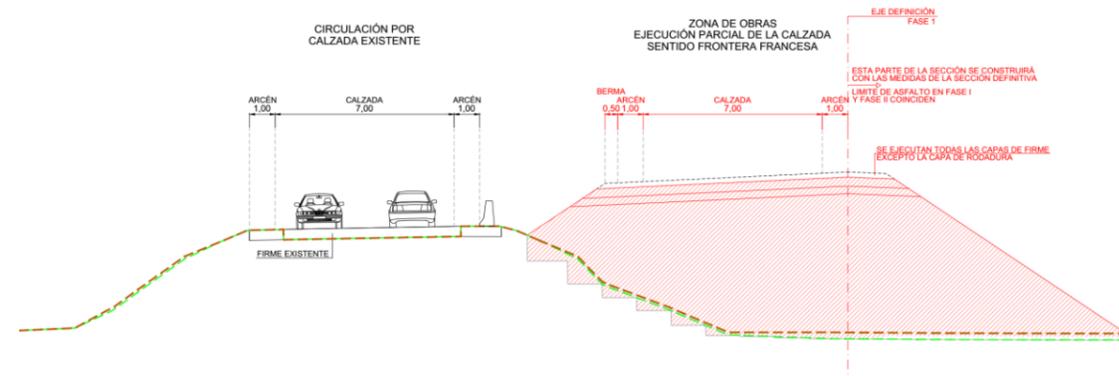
En rojo la zona de obras de la Fase 1. El tráfico circula por la N-II existente reduciendo la sección existente a 9m de ancho.
